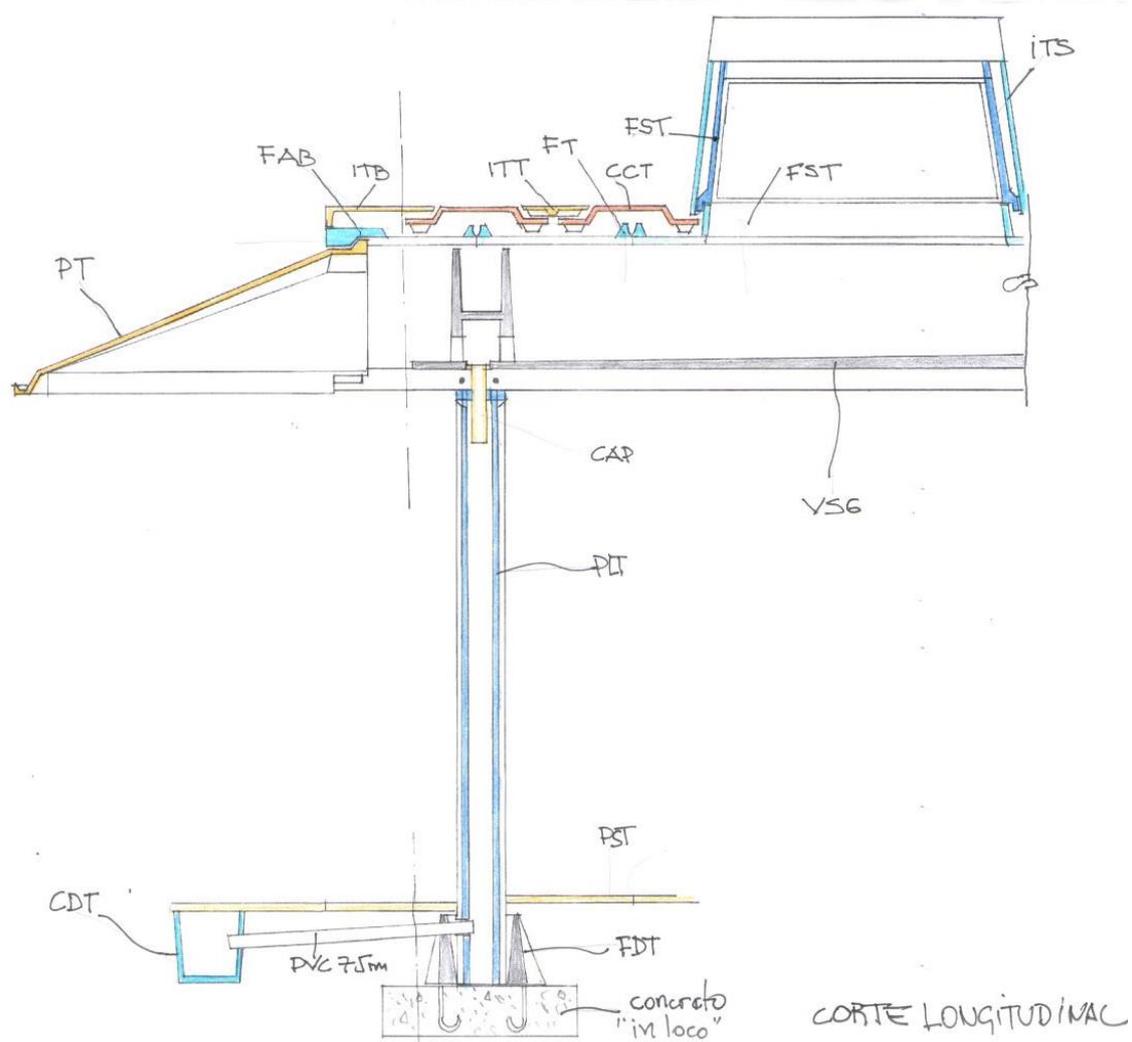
Corte Longitudinal do Módulo Tipo lado externo, da fundação até a cobertura.
